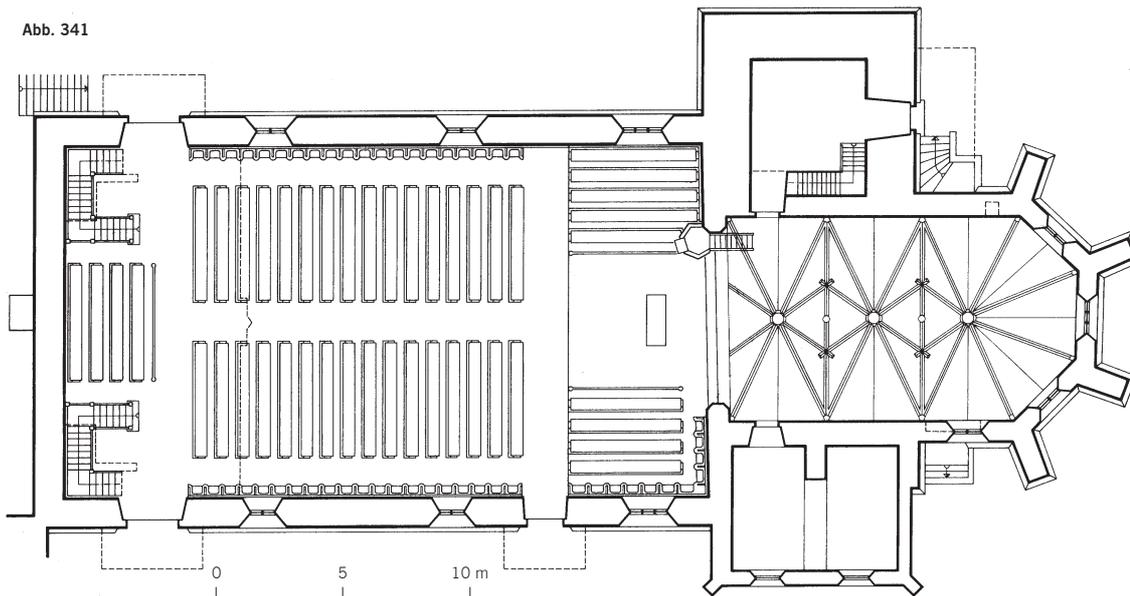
Elgg ZH, ref. Kirche. Grundriss 1:300.
